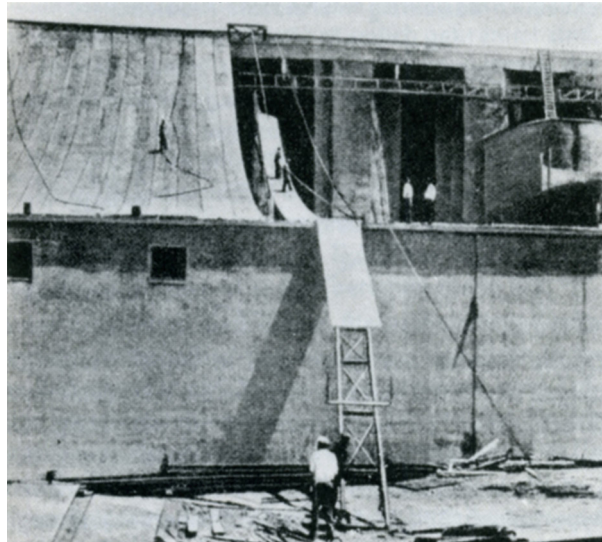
Blechdach einer Getreidelagerhalle in Albany während der Montage der Dachbahnen, Architekt: James Stewart (BNr. 73) [Otto 1954]
